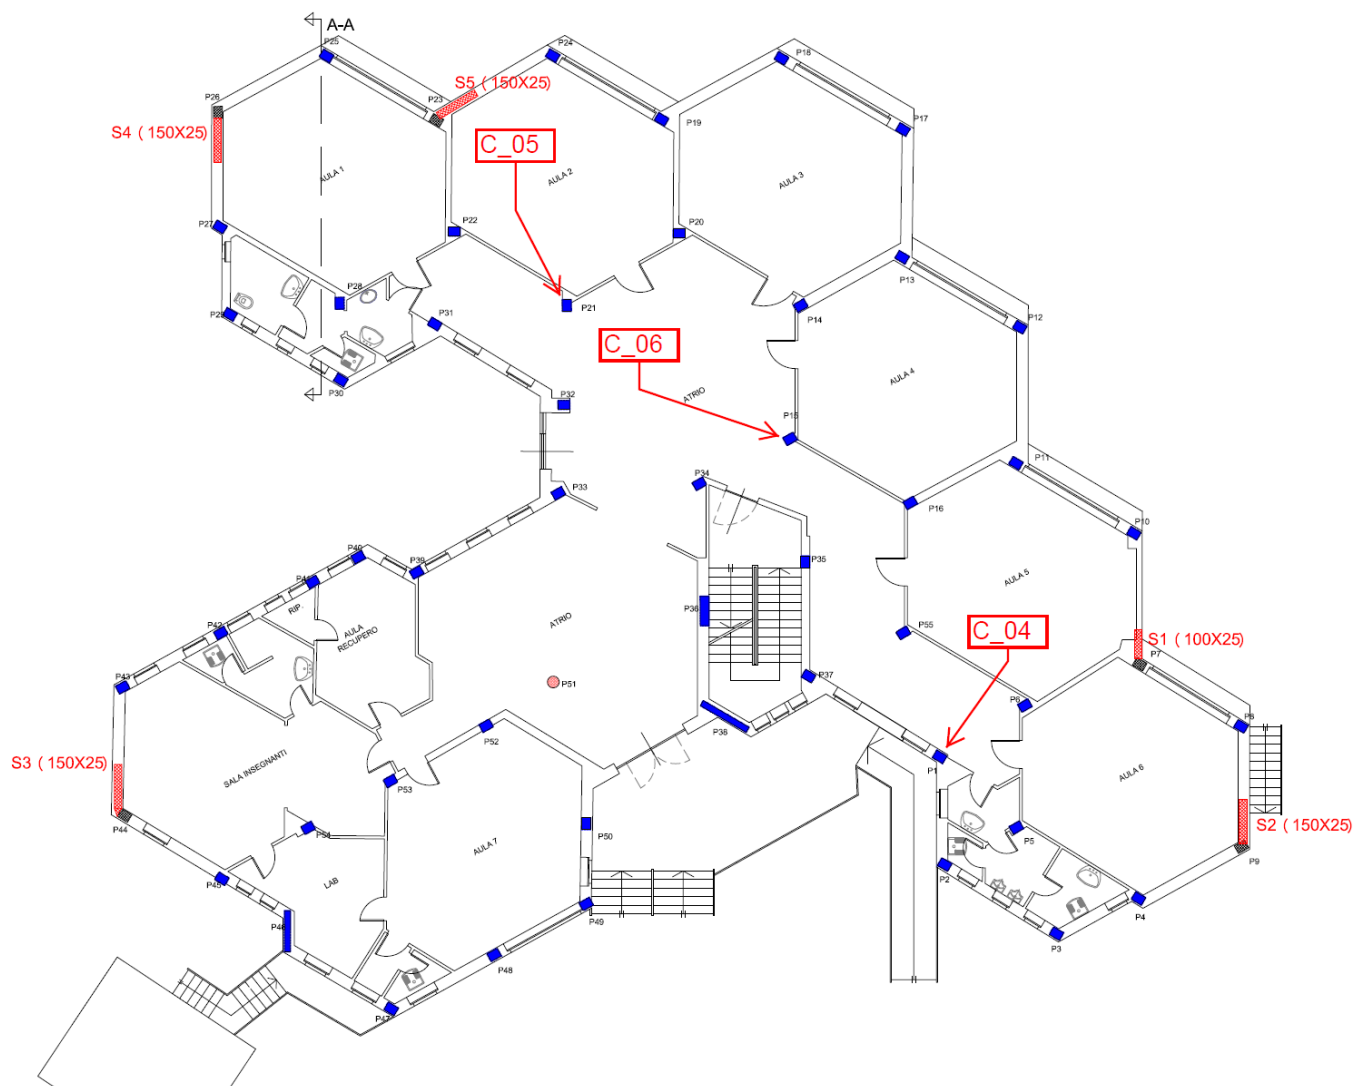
Localizzazione delle posizioni dei prelievi - plesso A - piano terra rialzato
